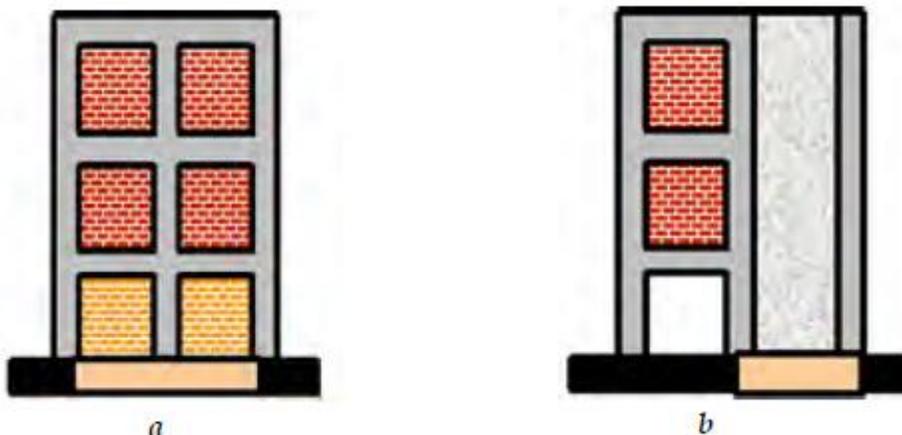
Las opciones para reforzar los edificios con planta baja abierta: (a) Rellenar las aberturas en la planta baja; y (b) instalación de muros de corte de CR continuos (fuente: C.V.R. Murty).
